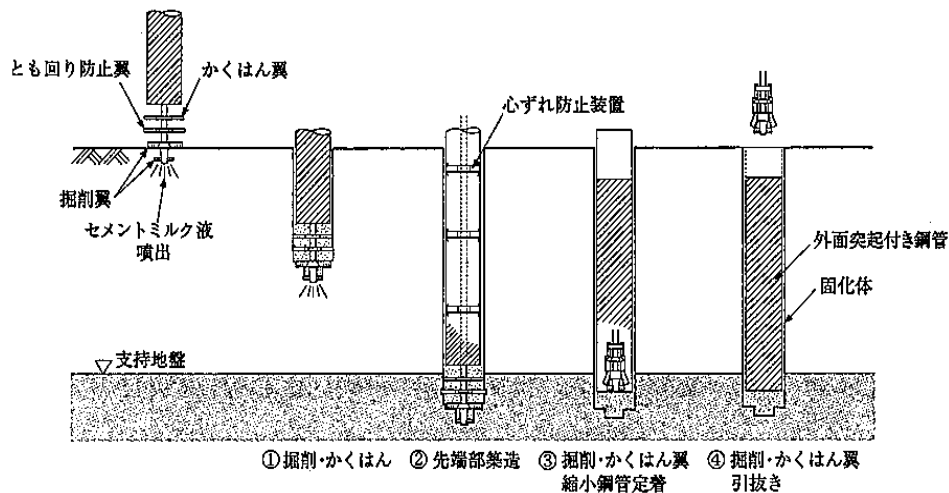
地盤改良による施工(鋼管ソイルセメント工法)¹⁷⁾
